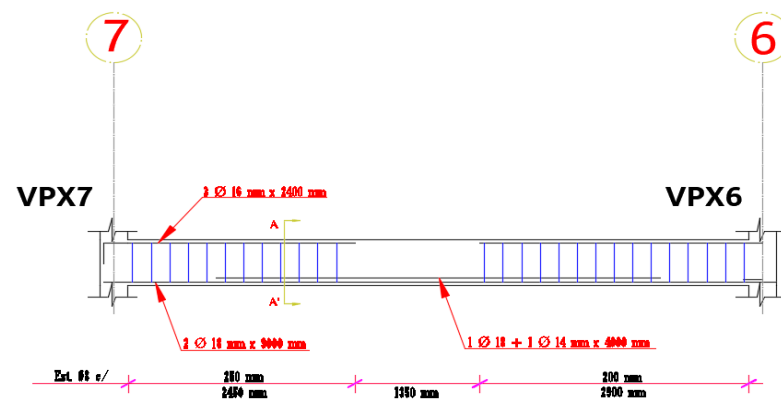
Detalle de viga secundaria, piso 2-3-4.
